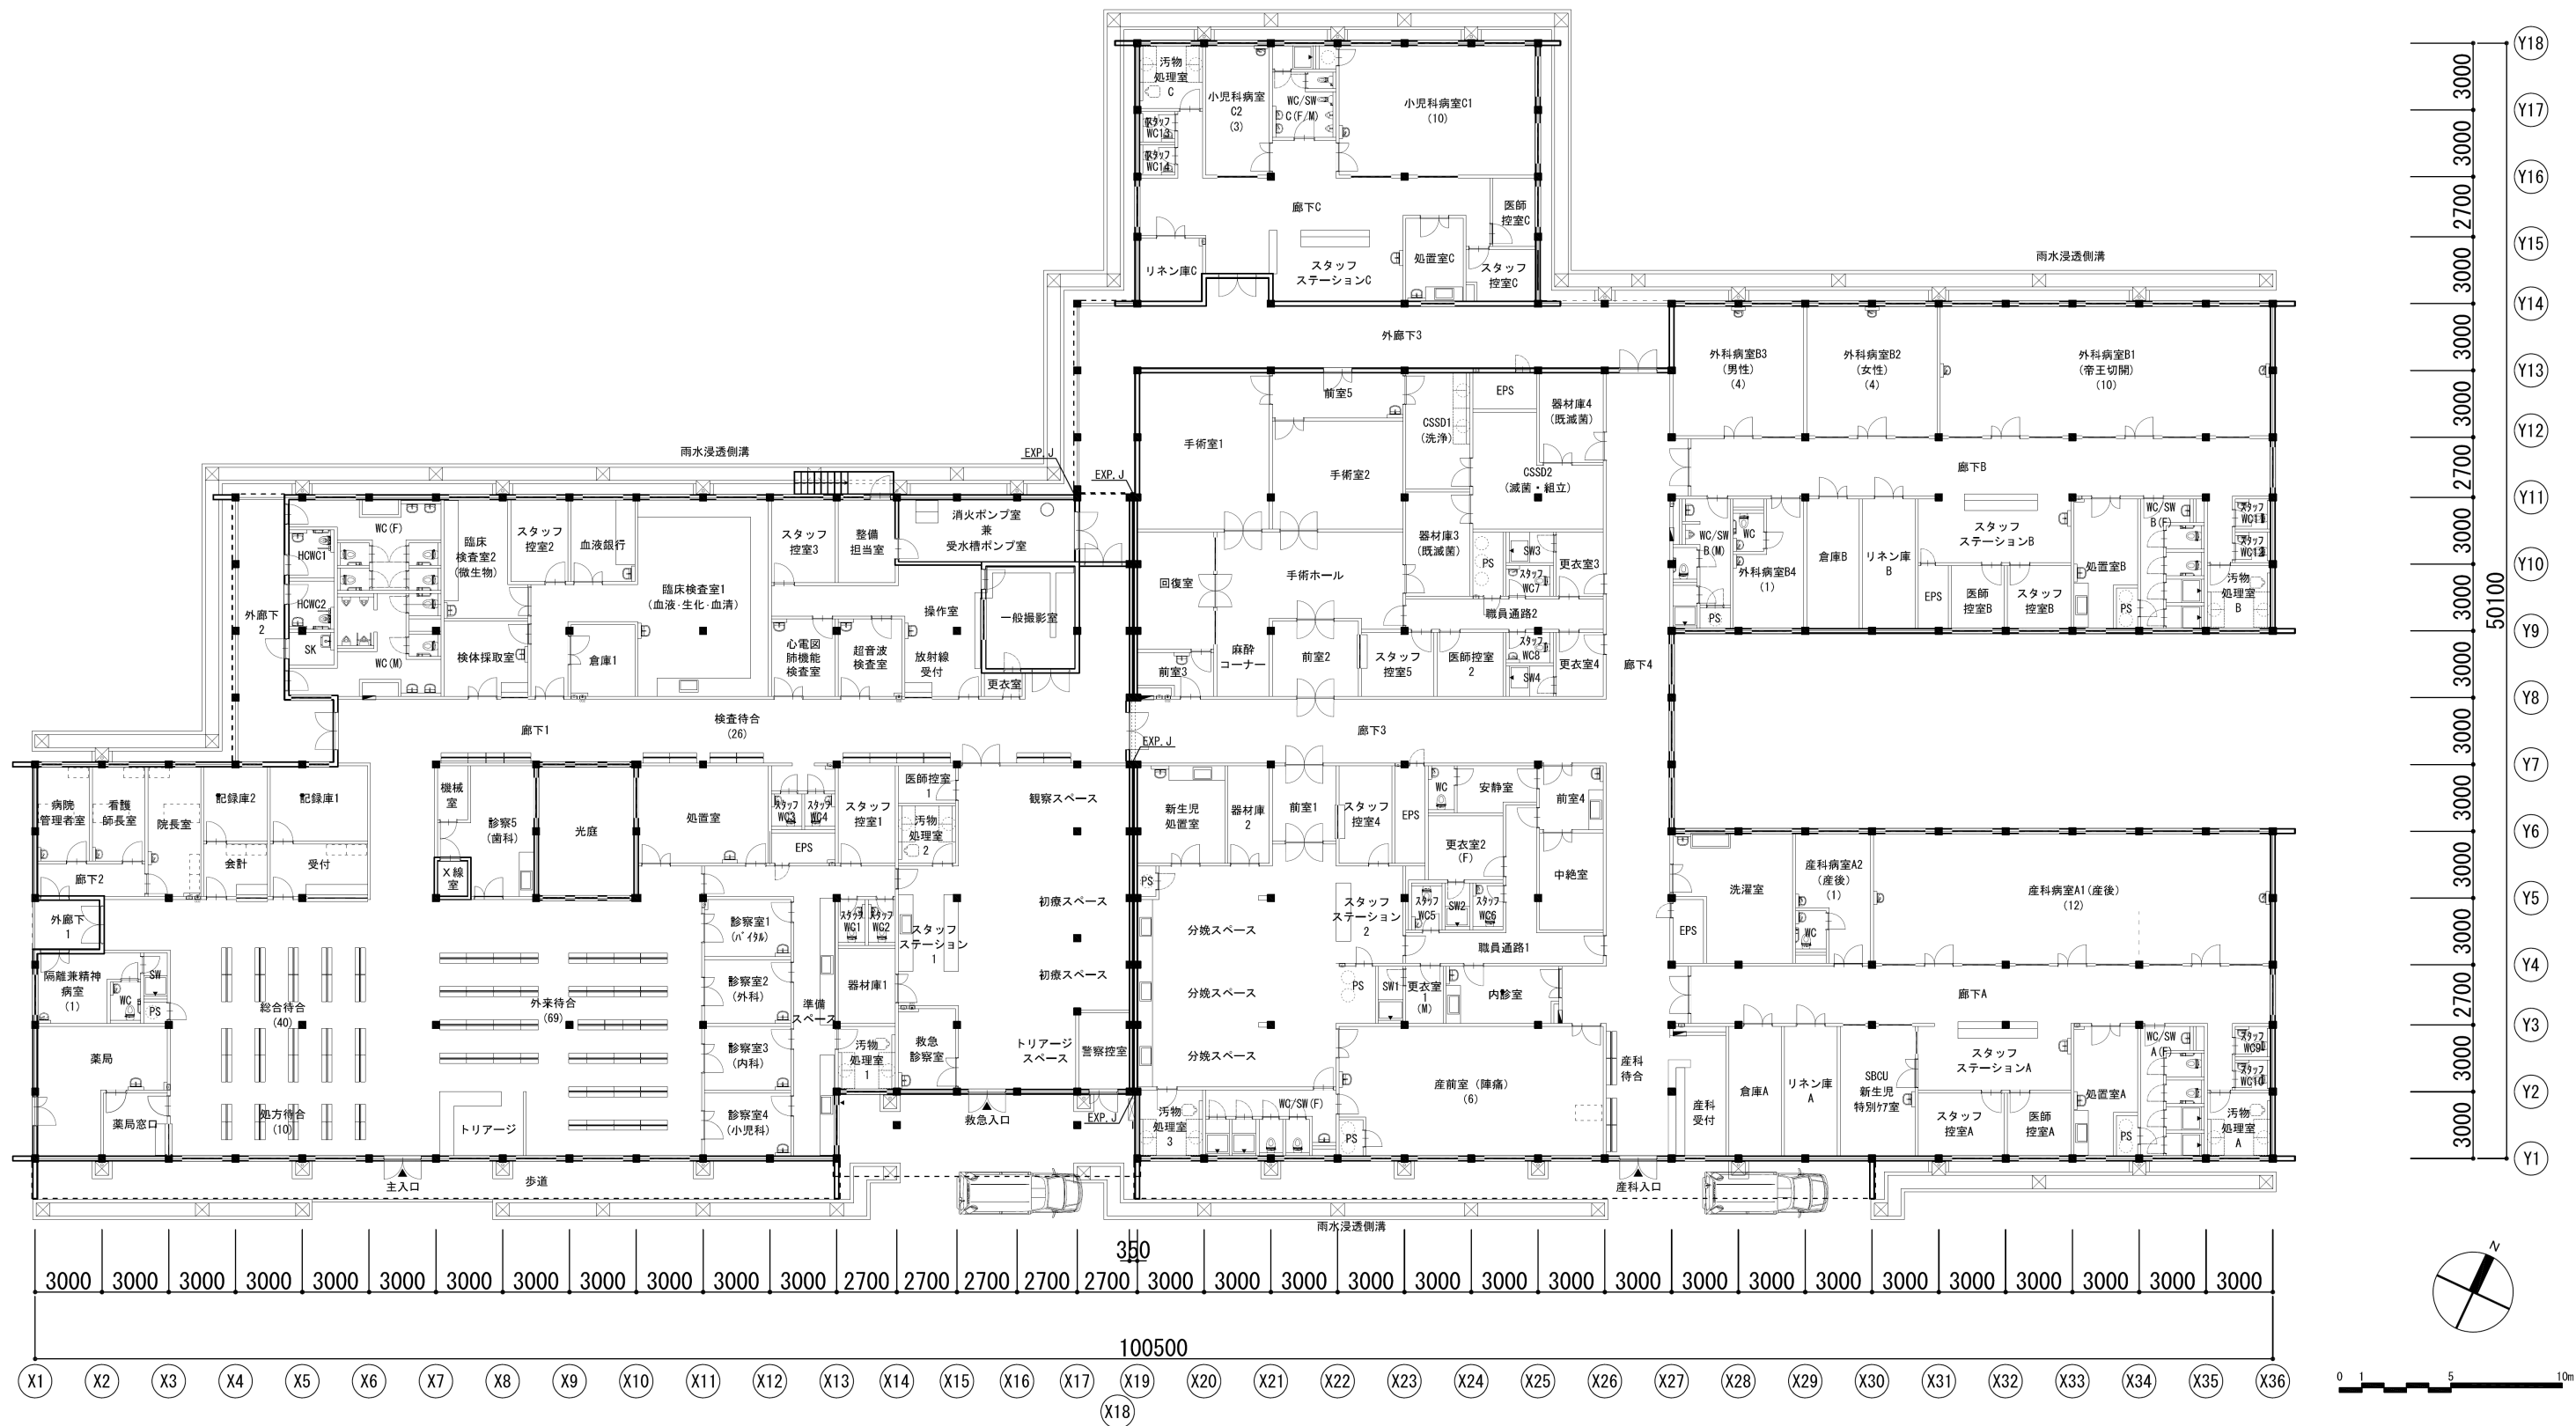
： チャンボリー次レベル病院 1階 平面図 1/300
